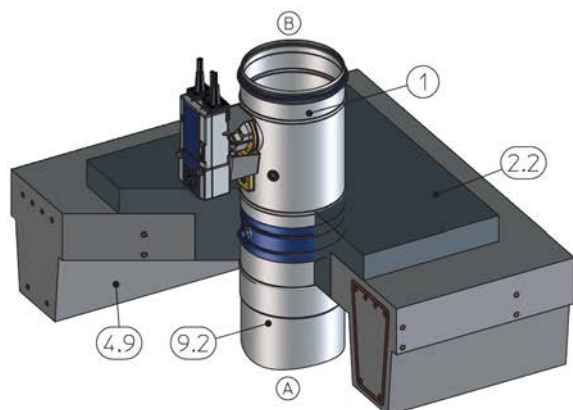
Монтаж с применением строительного раствора в многопустотных железобетонных плитах, на рисунке показано вертикальное расположение (также применимо для монтажа на подвесах)
